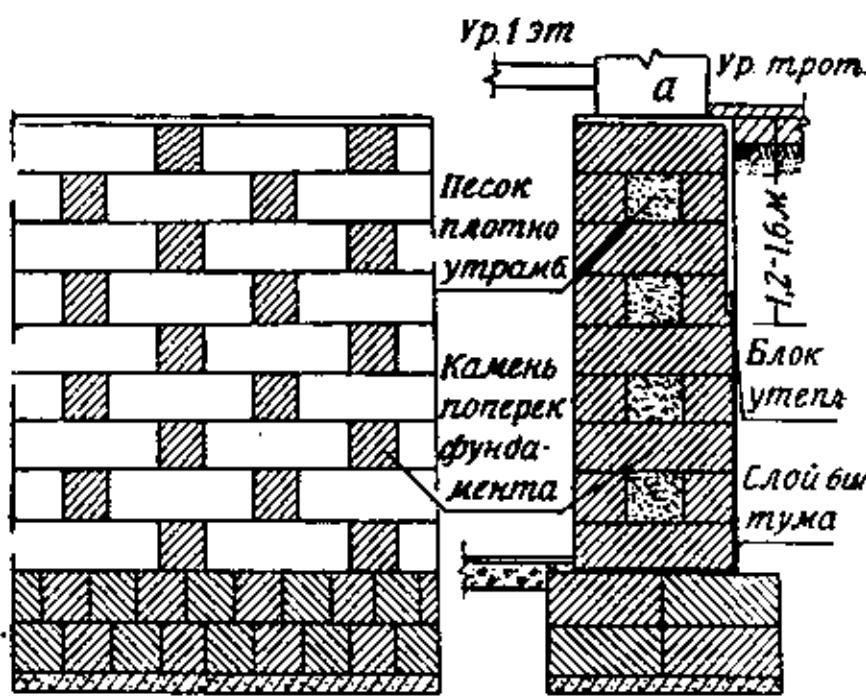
Столбовой фундамент с бетонной подушкой на грунте средней прочности
